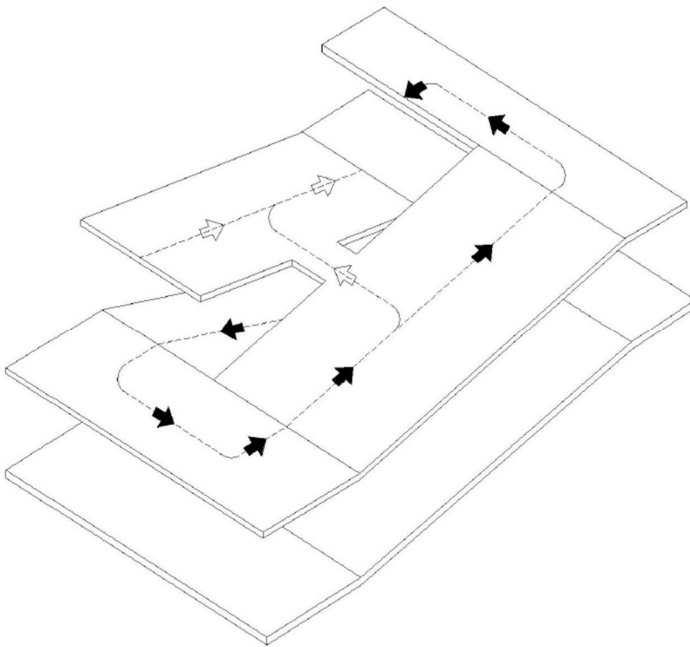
Rampa en medio de mitades de planta (c)
